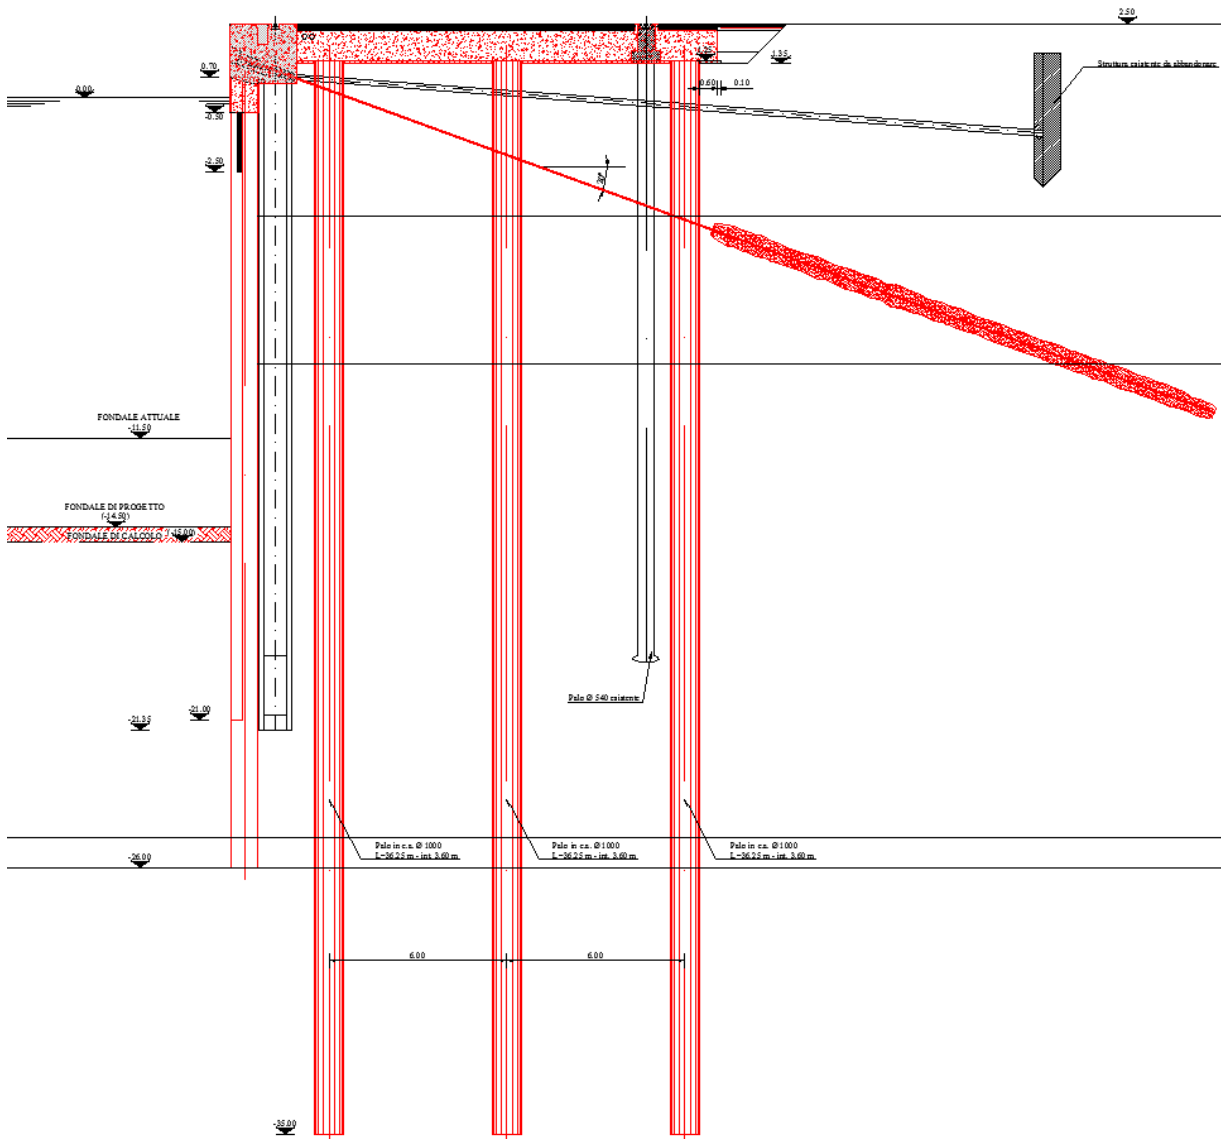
Sezione tipo della nuova banchina Lloyd (in rosso le nuove strutture)
